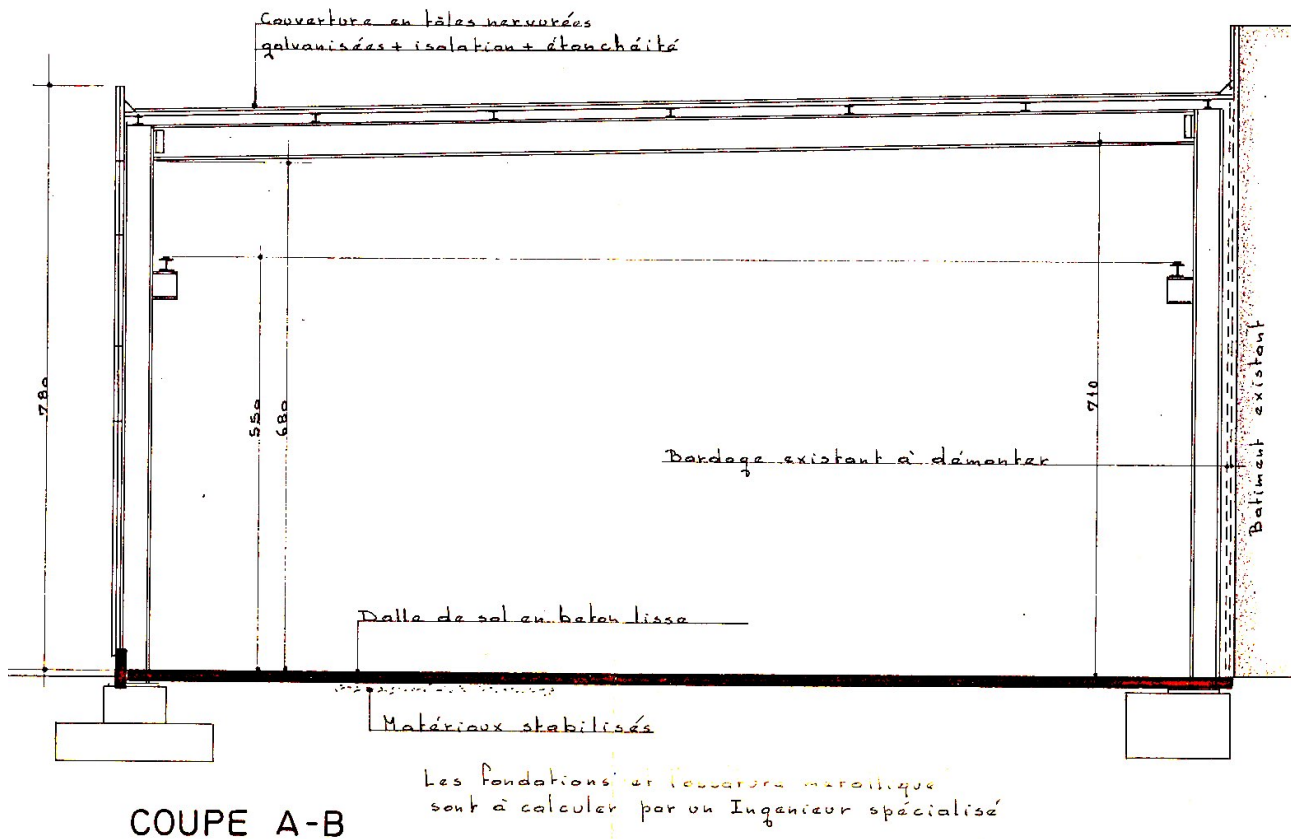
Coupe de l'extension, cas n°1 (Source : Archives de Liège)
